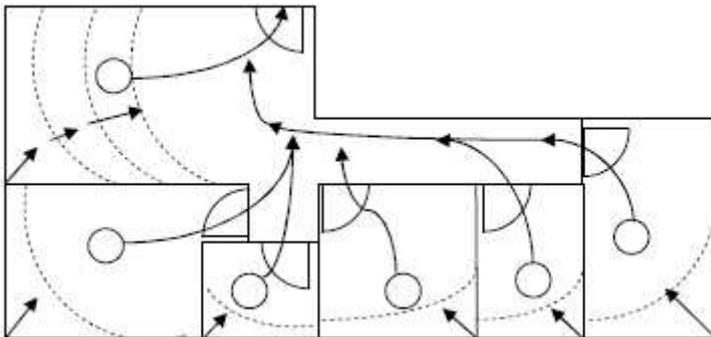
Planificación de trabajo en vivienda. 2014. Guía aplicación TopCiment.
